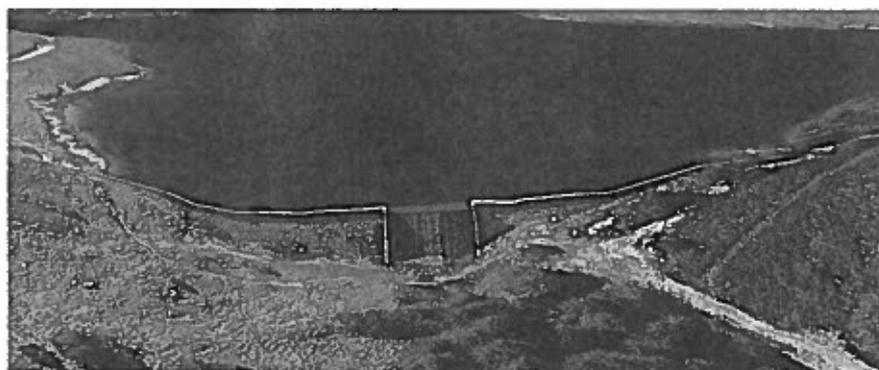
Parement amont du barrage (source : Google Earth)
